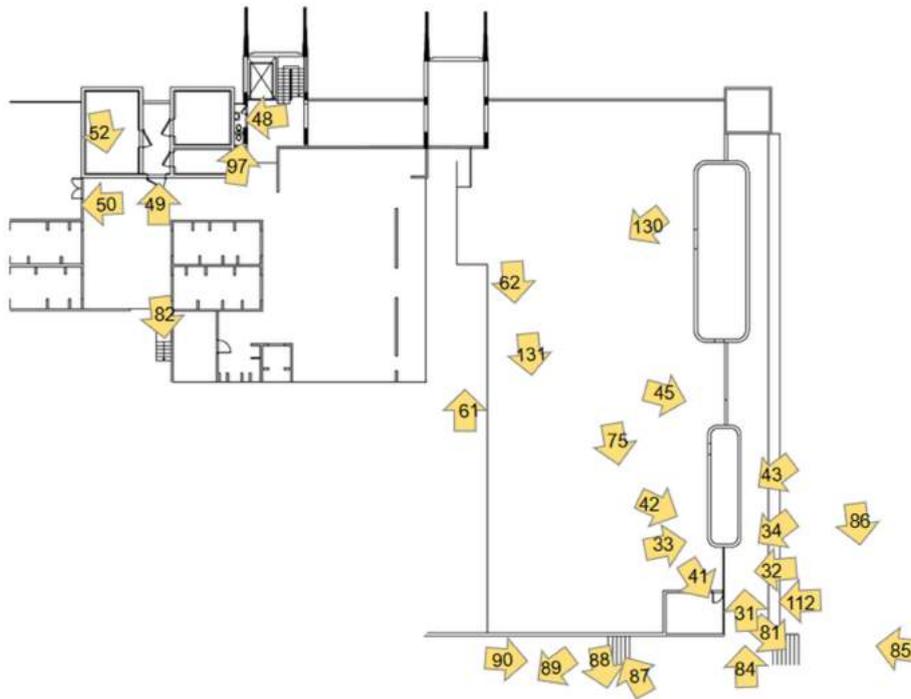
Planta do RU – térreo – Montagem Autor: Valentim, M. 2020
